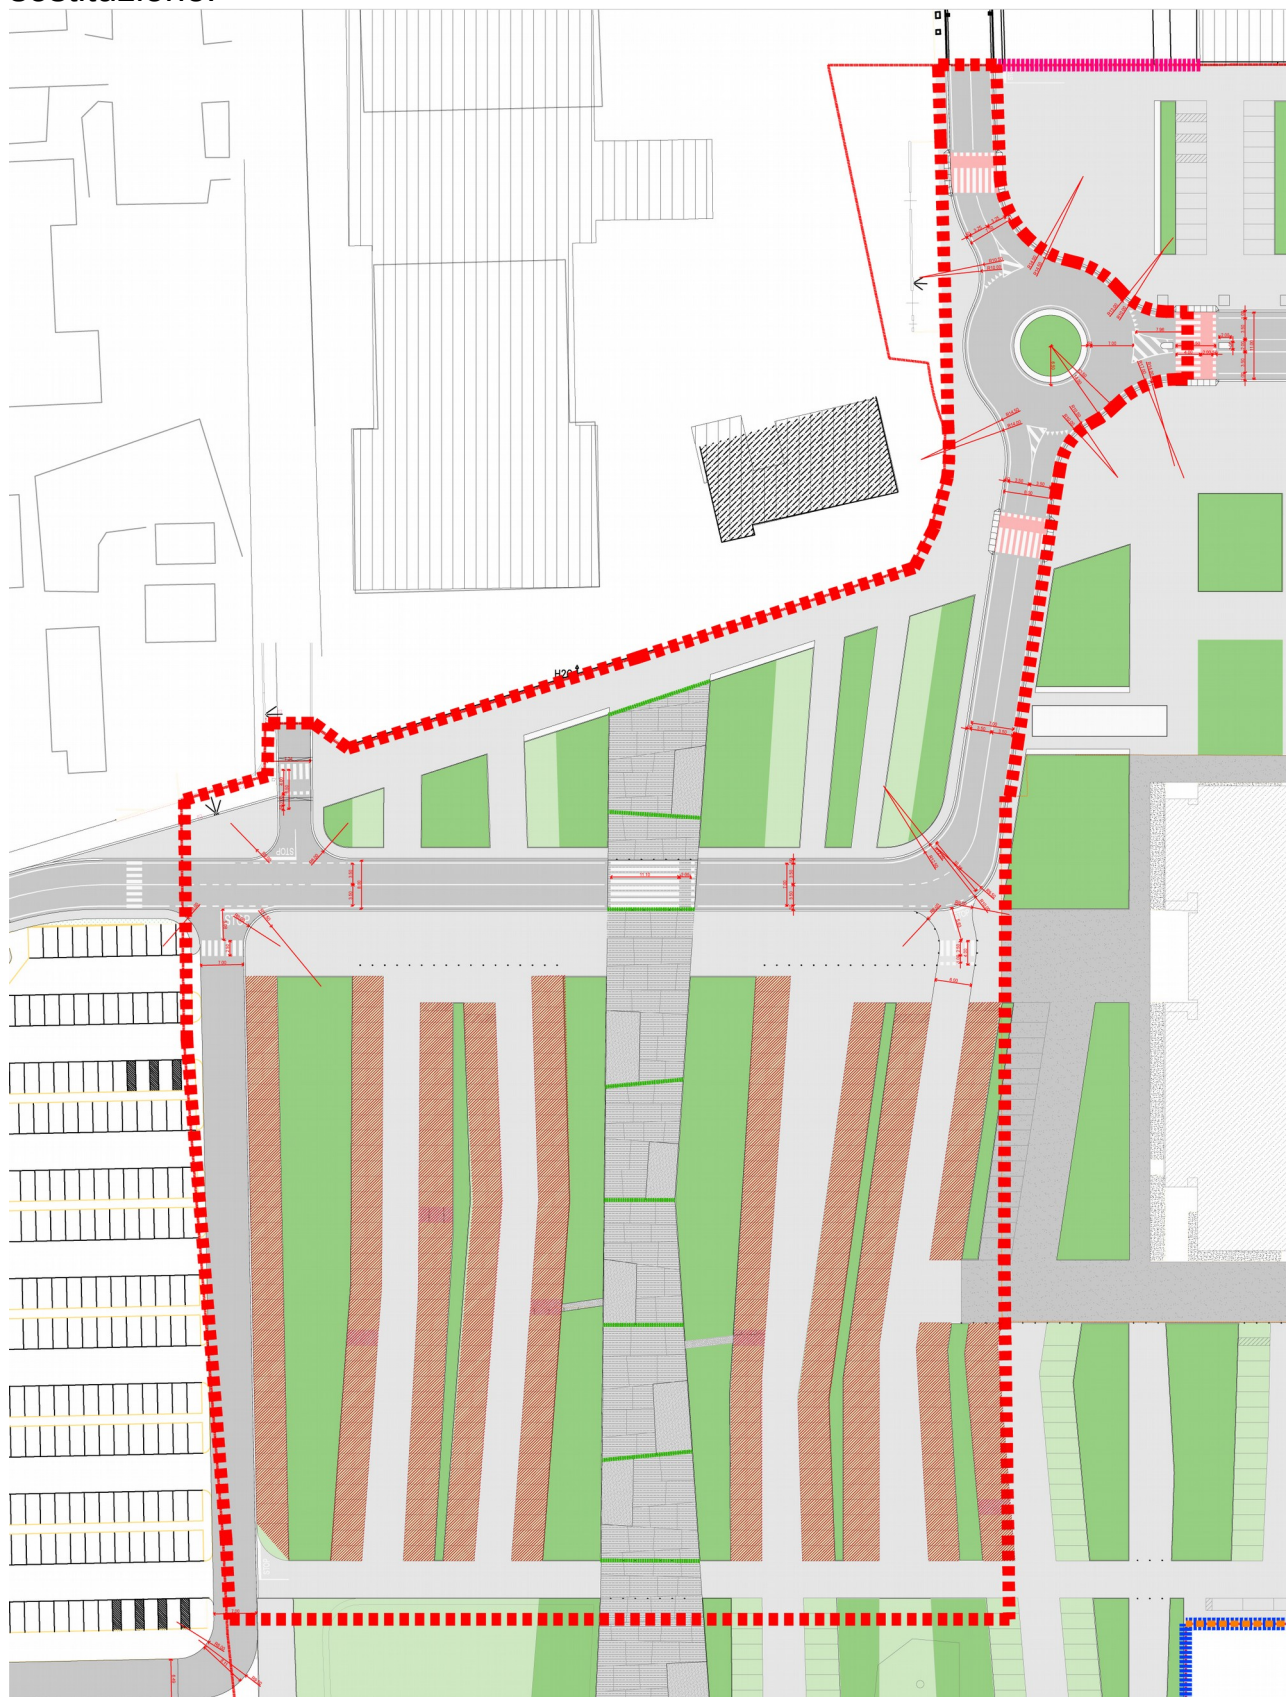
le aree segnate in rosso corrispondono alla pavimentazione in autobloccante ipotizzata in sostituzione.
